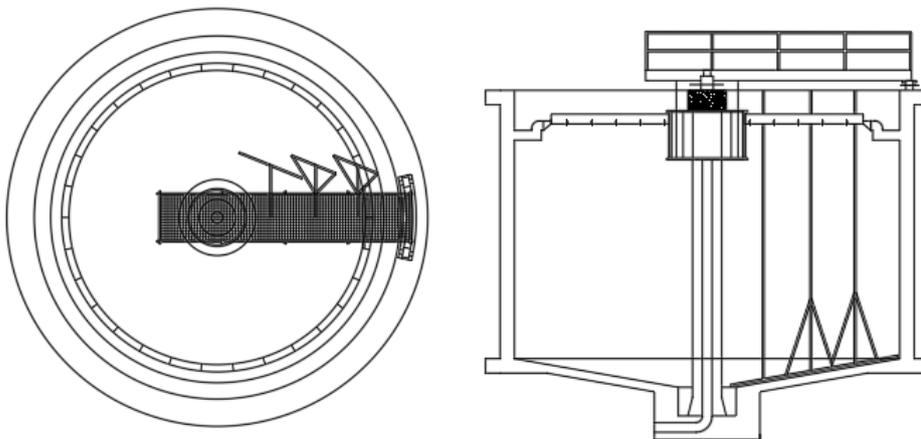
Detalle planta y alzado de decantador 2. Fuente: Edición propia
